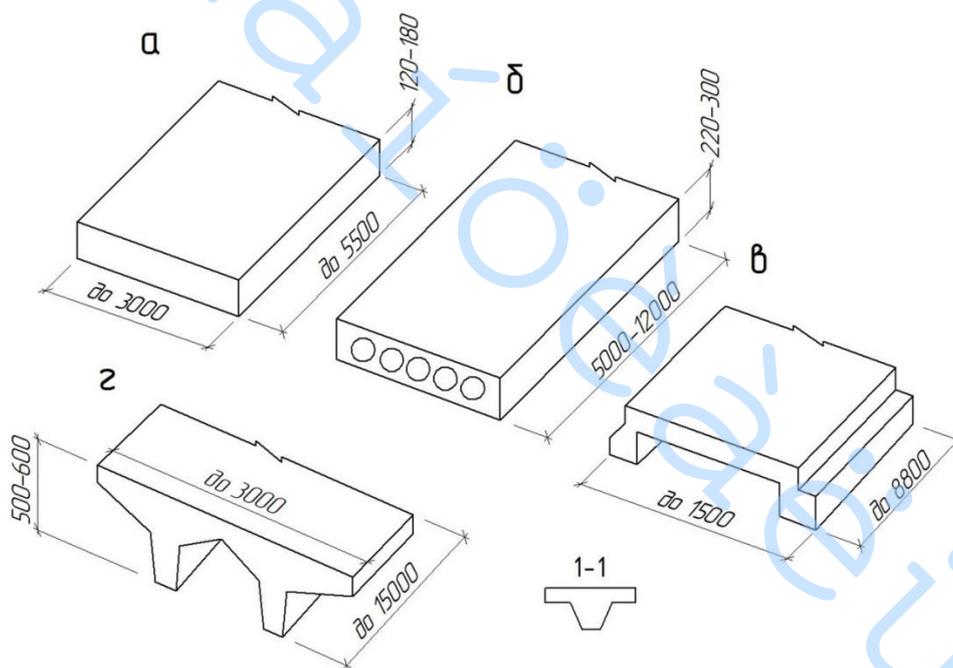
Некоторые виды железобетонных панелей перекрытий:
